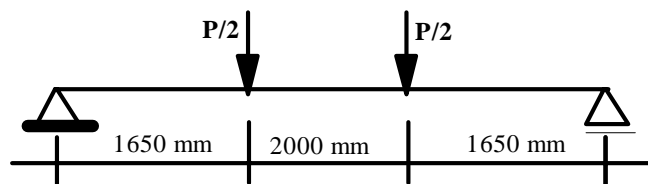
Aplicação das Cargas para as Vigas Ensaaiadas
